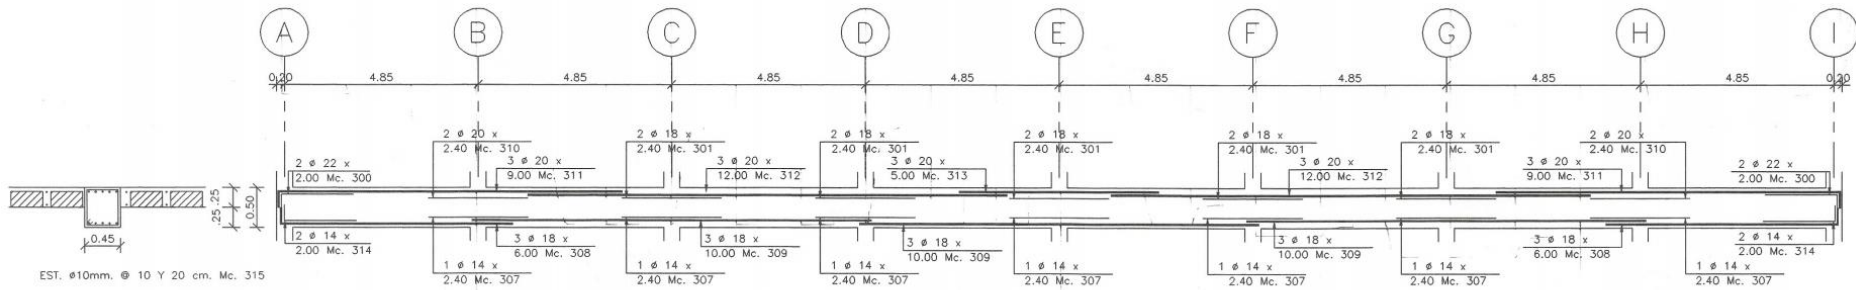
Secciones, Vigas – Sentido Y, Edificación en análisis
